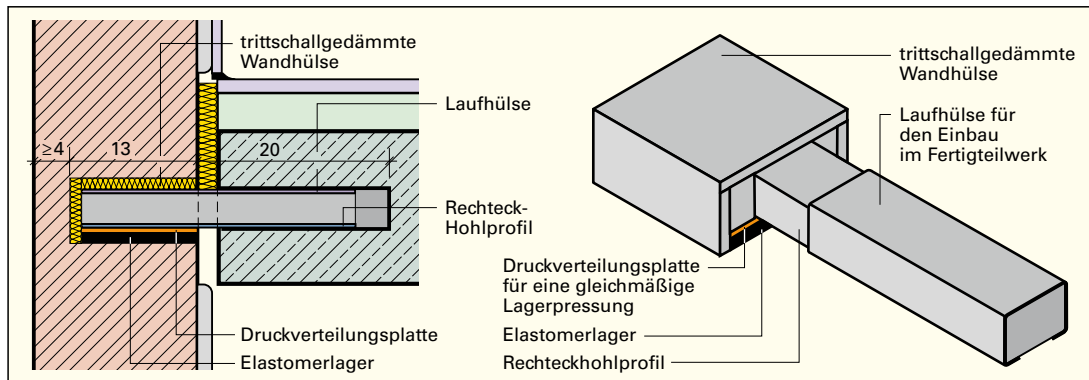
Einbau einer Wandhülse mit Stahlrohr
